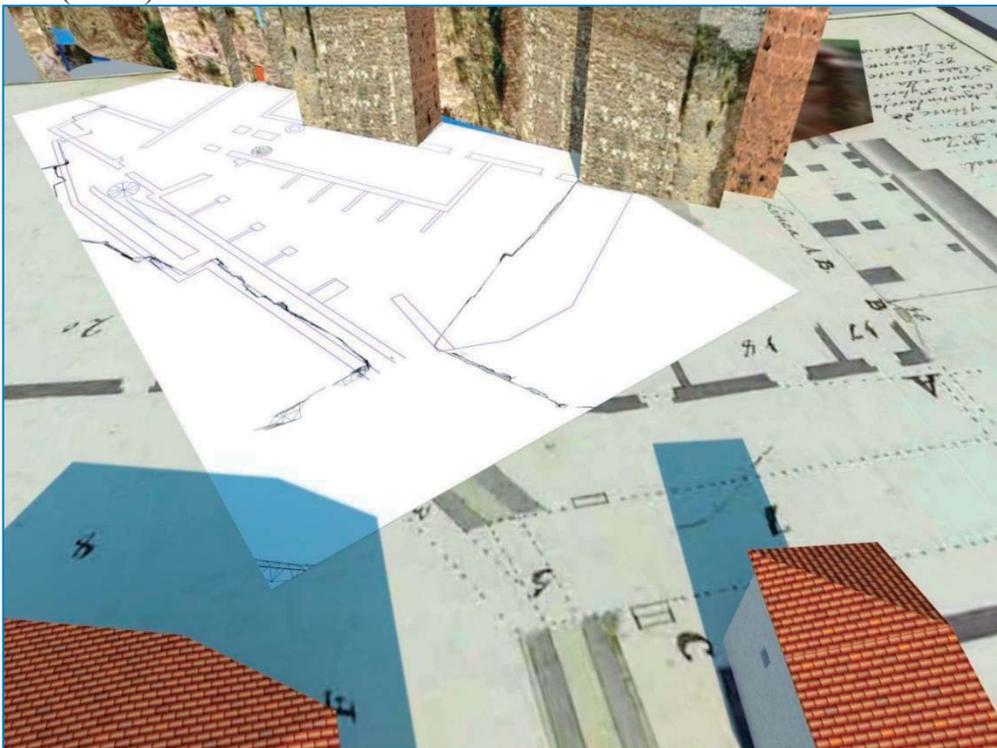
Reconstrucción de viviendas de la zona Norte sobre plano de litigio.
